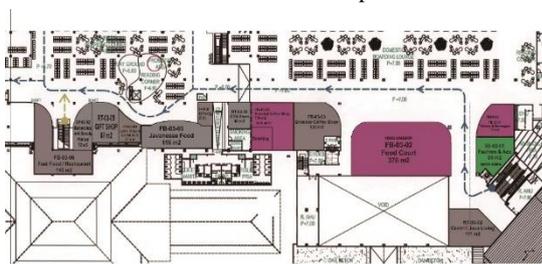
Denah lantai 1 Bandar Udara Adi Soemarmo
